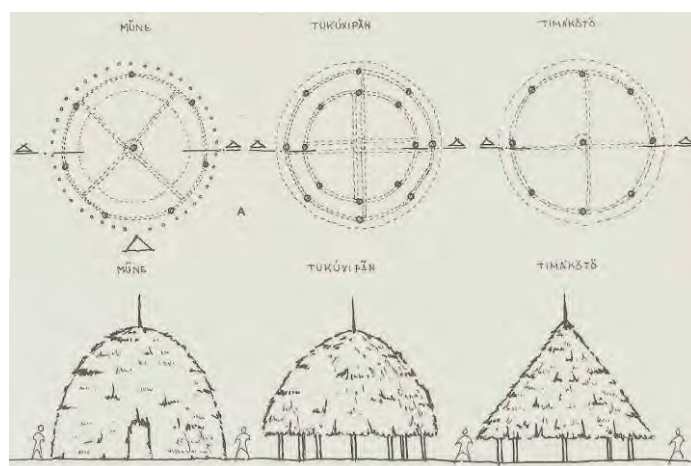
Plantas y alzados de la Casa Tiriyó. Fuente: COSTA Y MALHANO, 1987.
